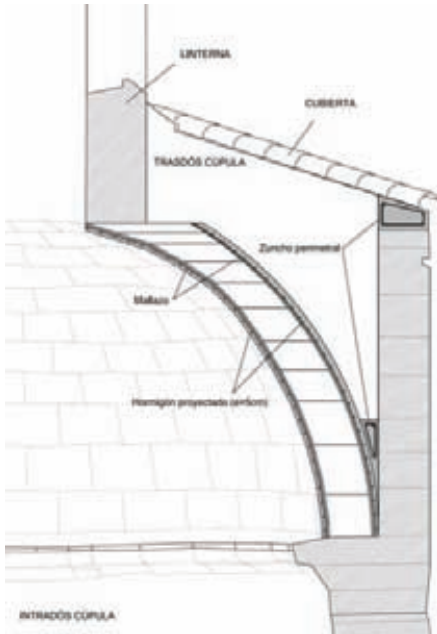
, 40 y 41: Refuerzo de hormigón proyectado.
